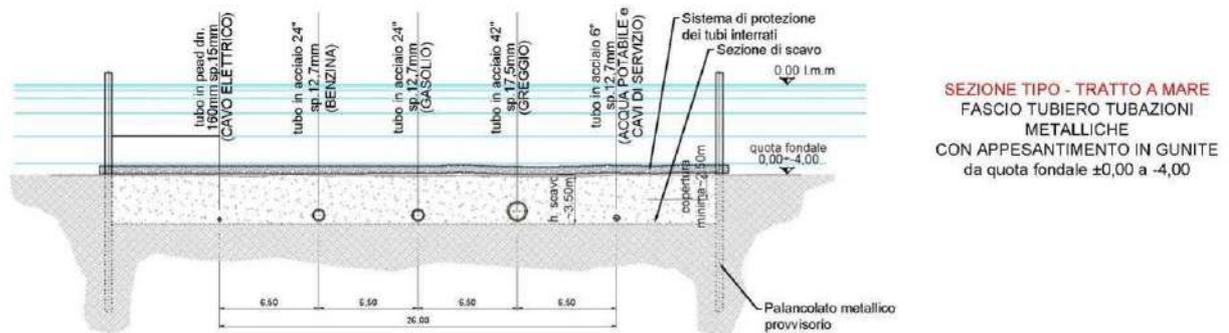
Fascio tubiero - tratto a mare: sezione di posa fino da quota fondale 0.00 a -4.00 m slmm.
